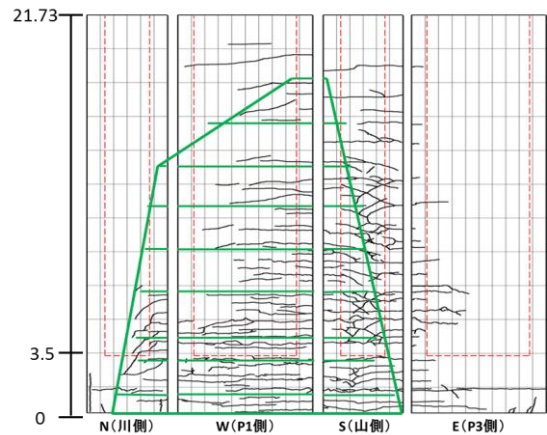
P2橋脚ひび割れ再現図(基礎の回転を考慮)
